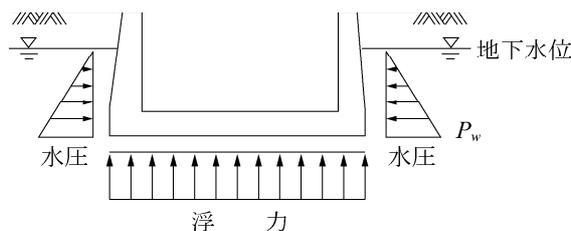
U 型擁壁に作用する水圧及び浮力
